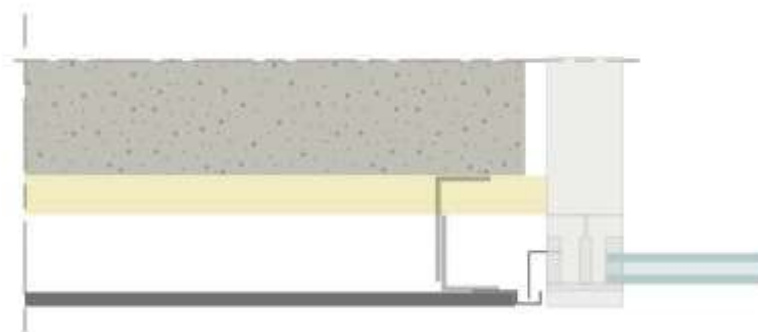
EQUITONE и боковая сторона светопрозрачного фасада
